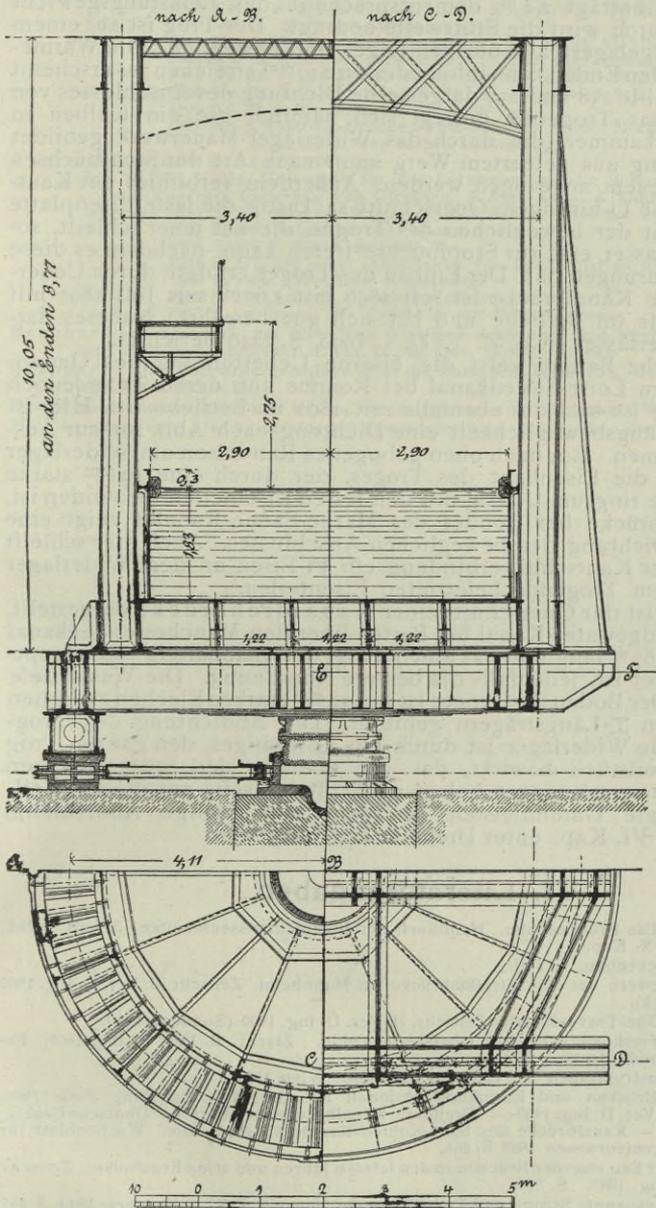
Querschnitt der Kanaldrehbrücke zur Ueberführung des Bridgewater-Kanals über den Manchester-Seekanal bei Barton. Aus D. B.-Z. 1894, S. 405.
